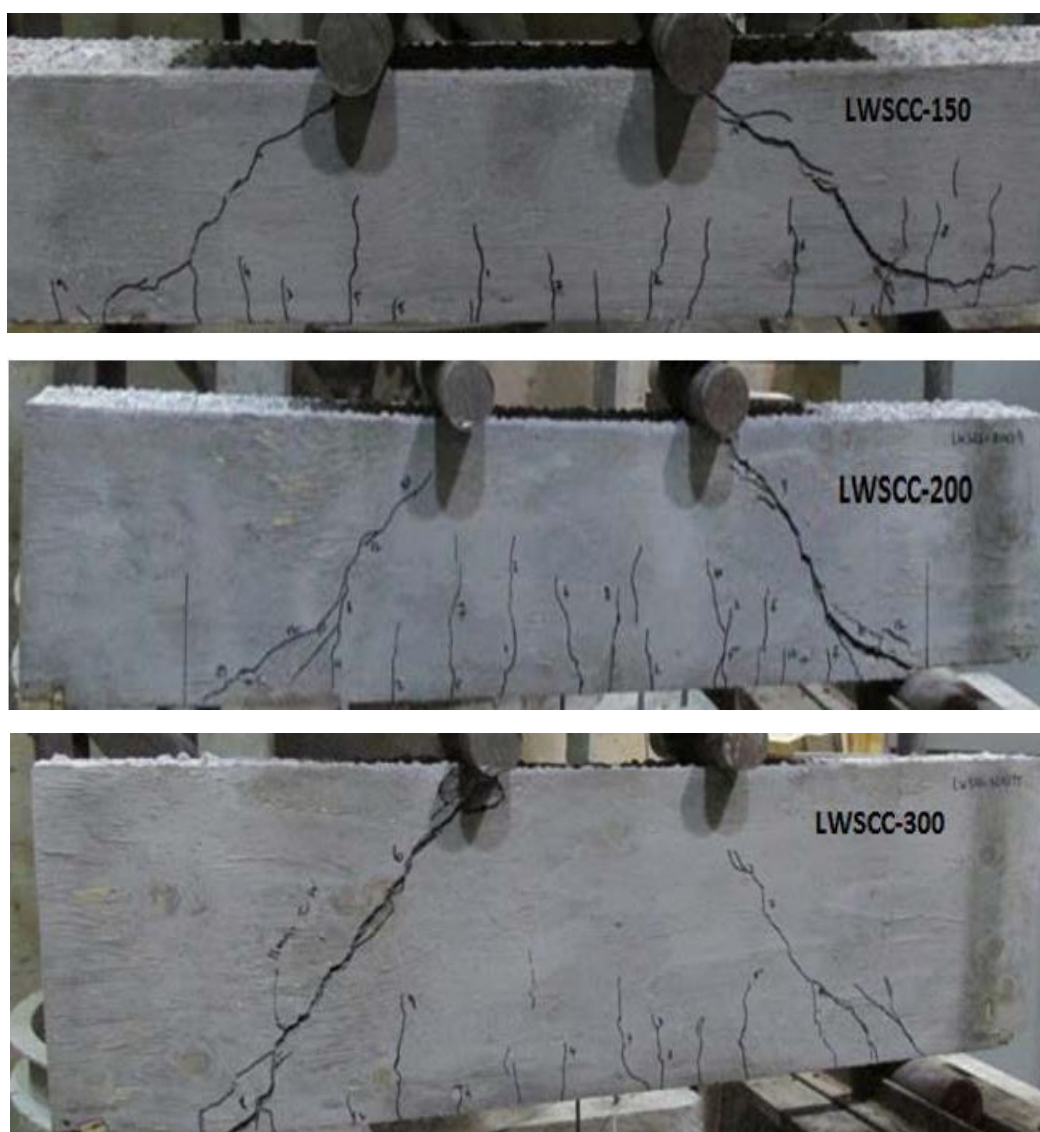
Padrão de fissuração das vigas de CLAA-150, CLAA-200 e CLAA-300 (Sathiyamoorthy, 2016).
